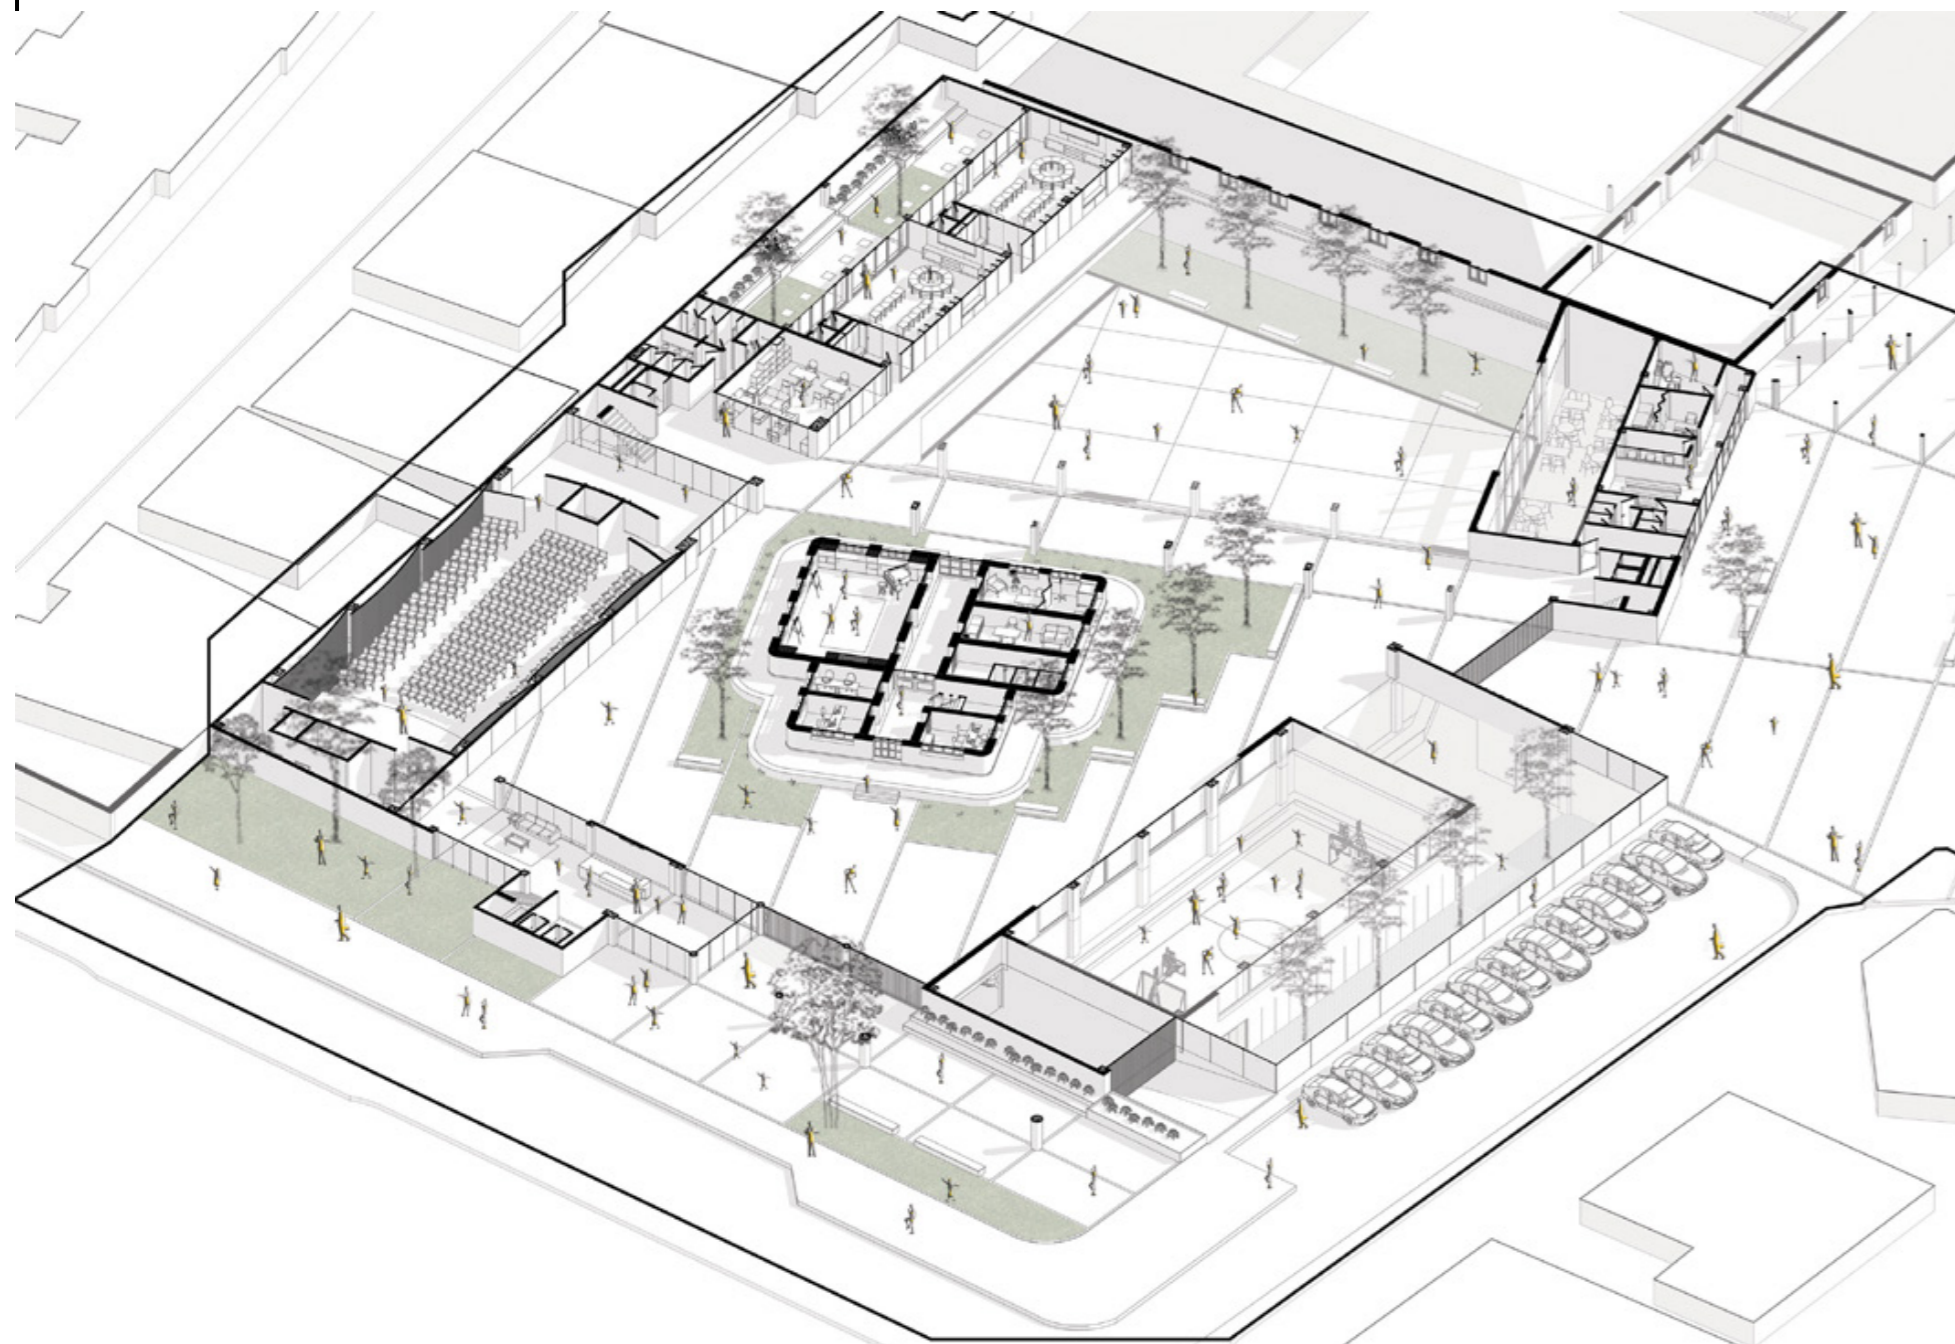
Axonometría Planta Baja | Fuente: Elaboración propia
